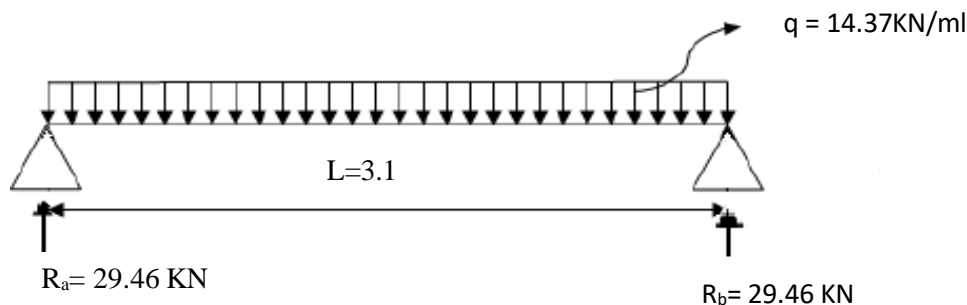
schéma statique de la poutre de chaînage à l'ELU
